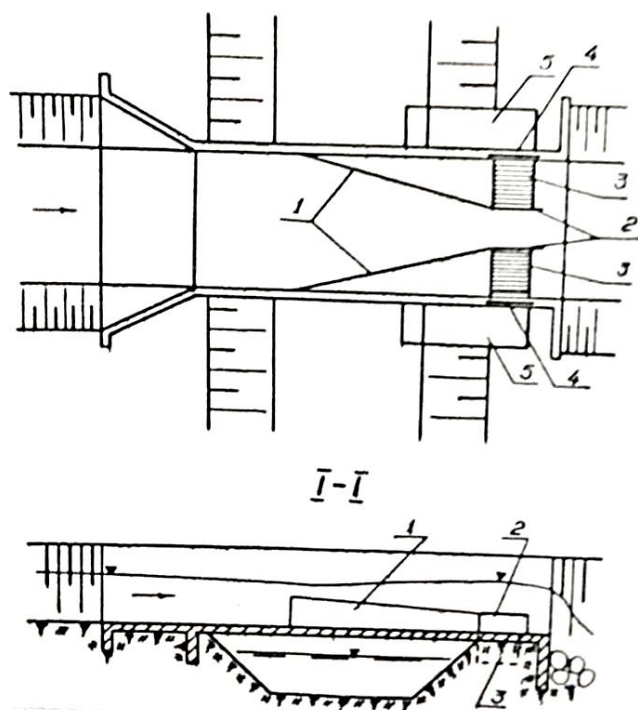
Схема водозабора, совмещенного с водопропускным сооружением:
